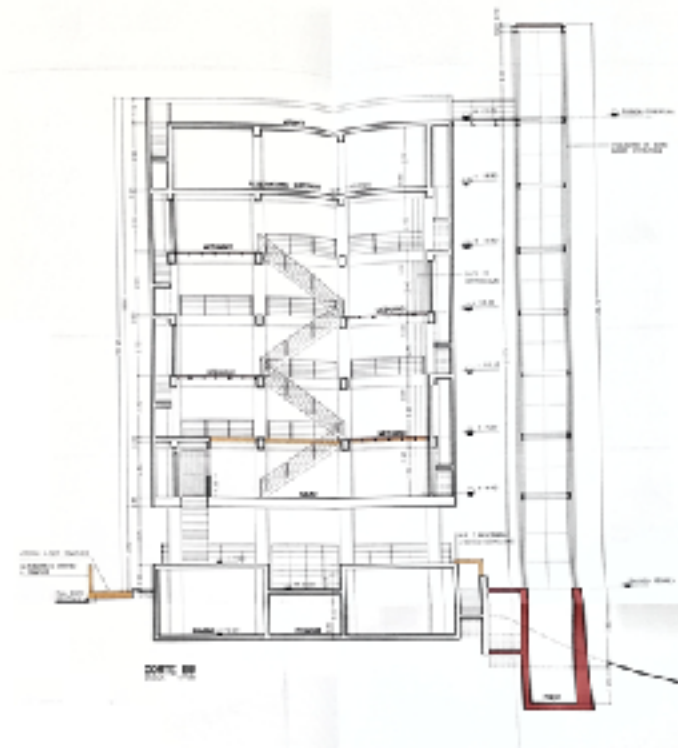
Corte do projeto de intervenção, em vermelho elementos a serem construídos e em amarelo elementos a serem retirados.
